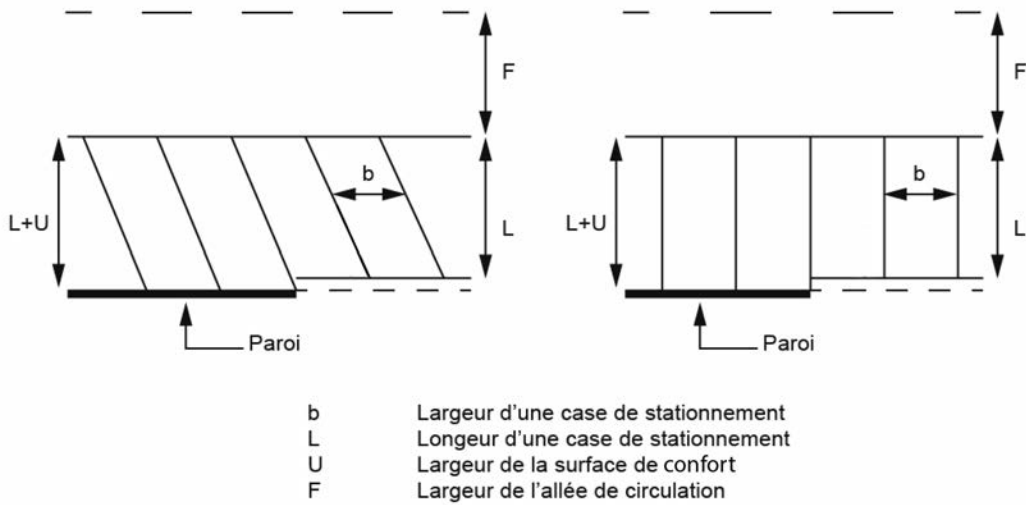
Dimension du stationnement oblique et perpendiculaire
